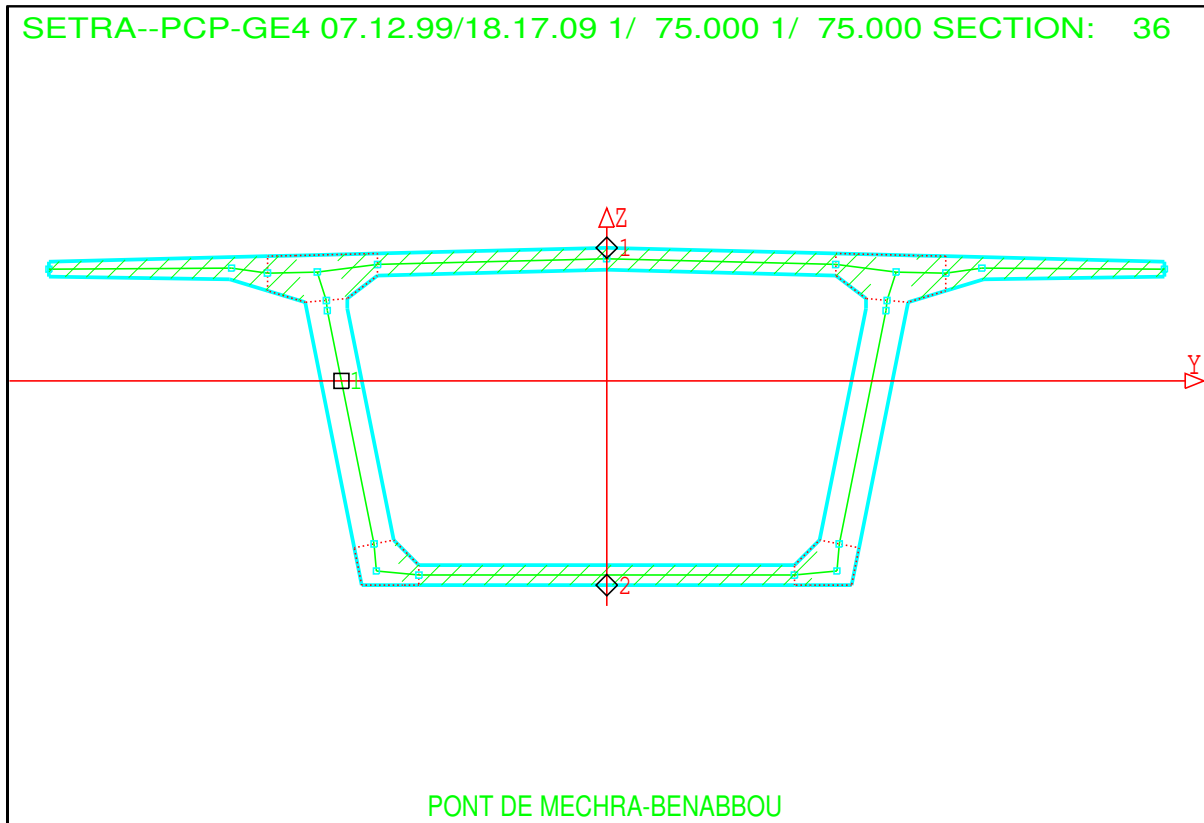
Poutre spatiale, coupe transversale, coffrage, parois minces
